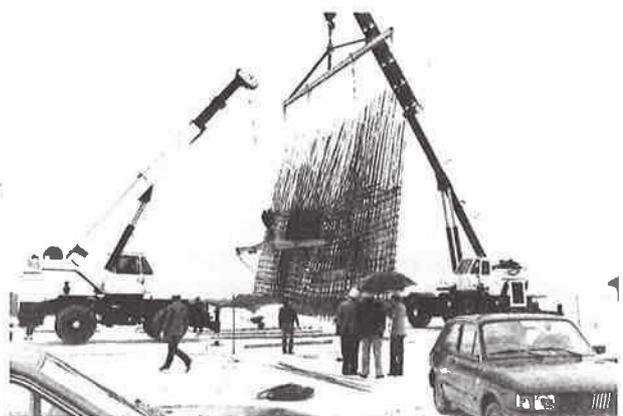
Prova di movimentazione di una gabbia prototipo irrigidita con barre aggiuntive.
